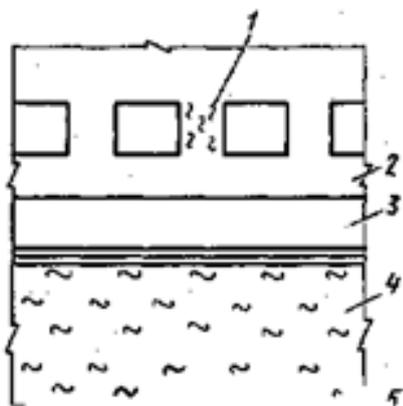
Образование трещин в кладке при концентрации напряжений: 1 — зона концентрации напряжений; 2 — стена; 3 — фундамент; 4 — сильносжимаемый грунт; 5 — мало-сжимаемый грунт
